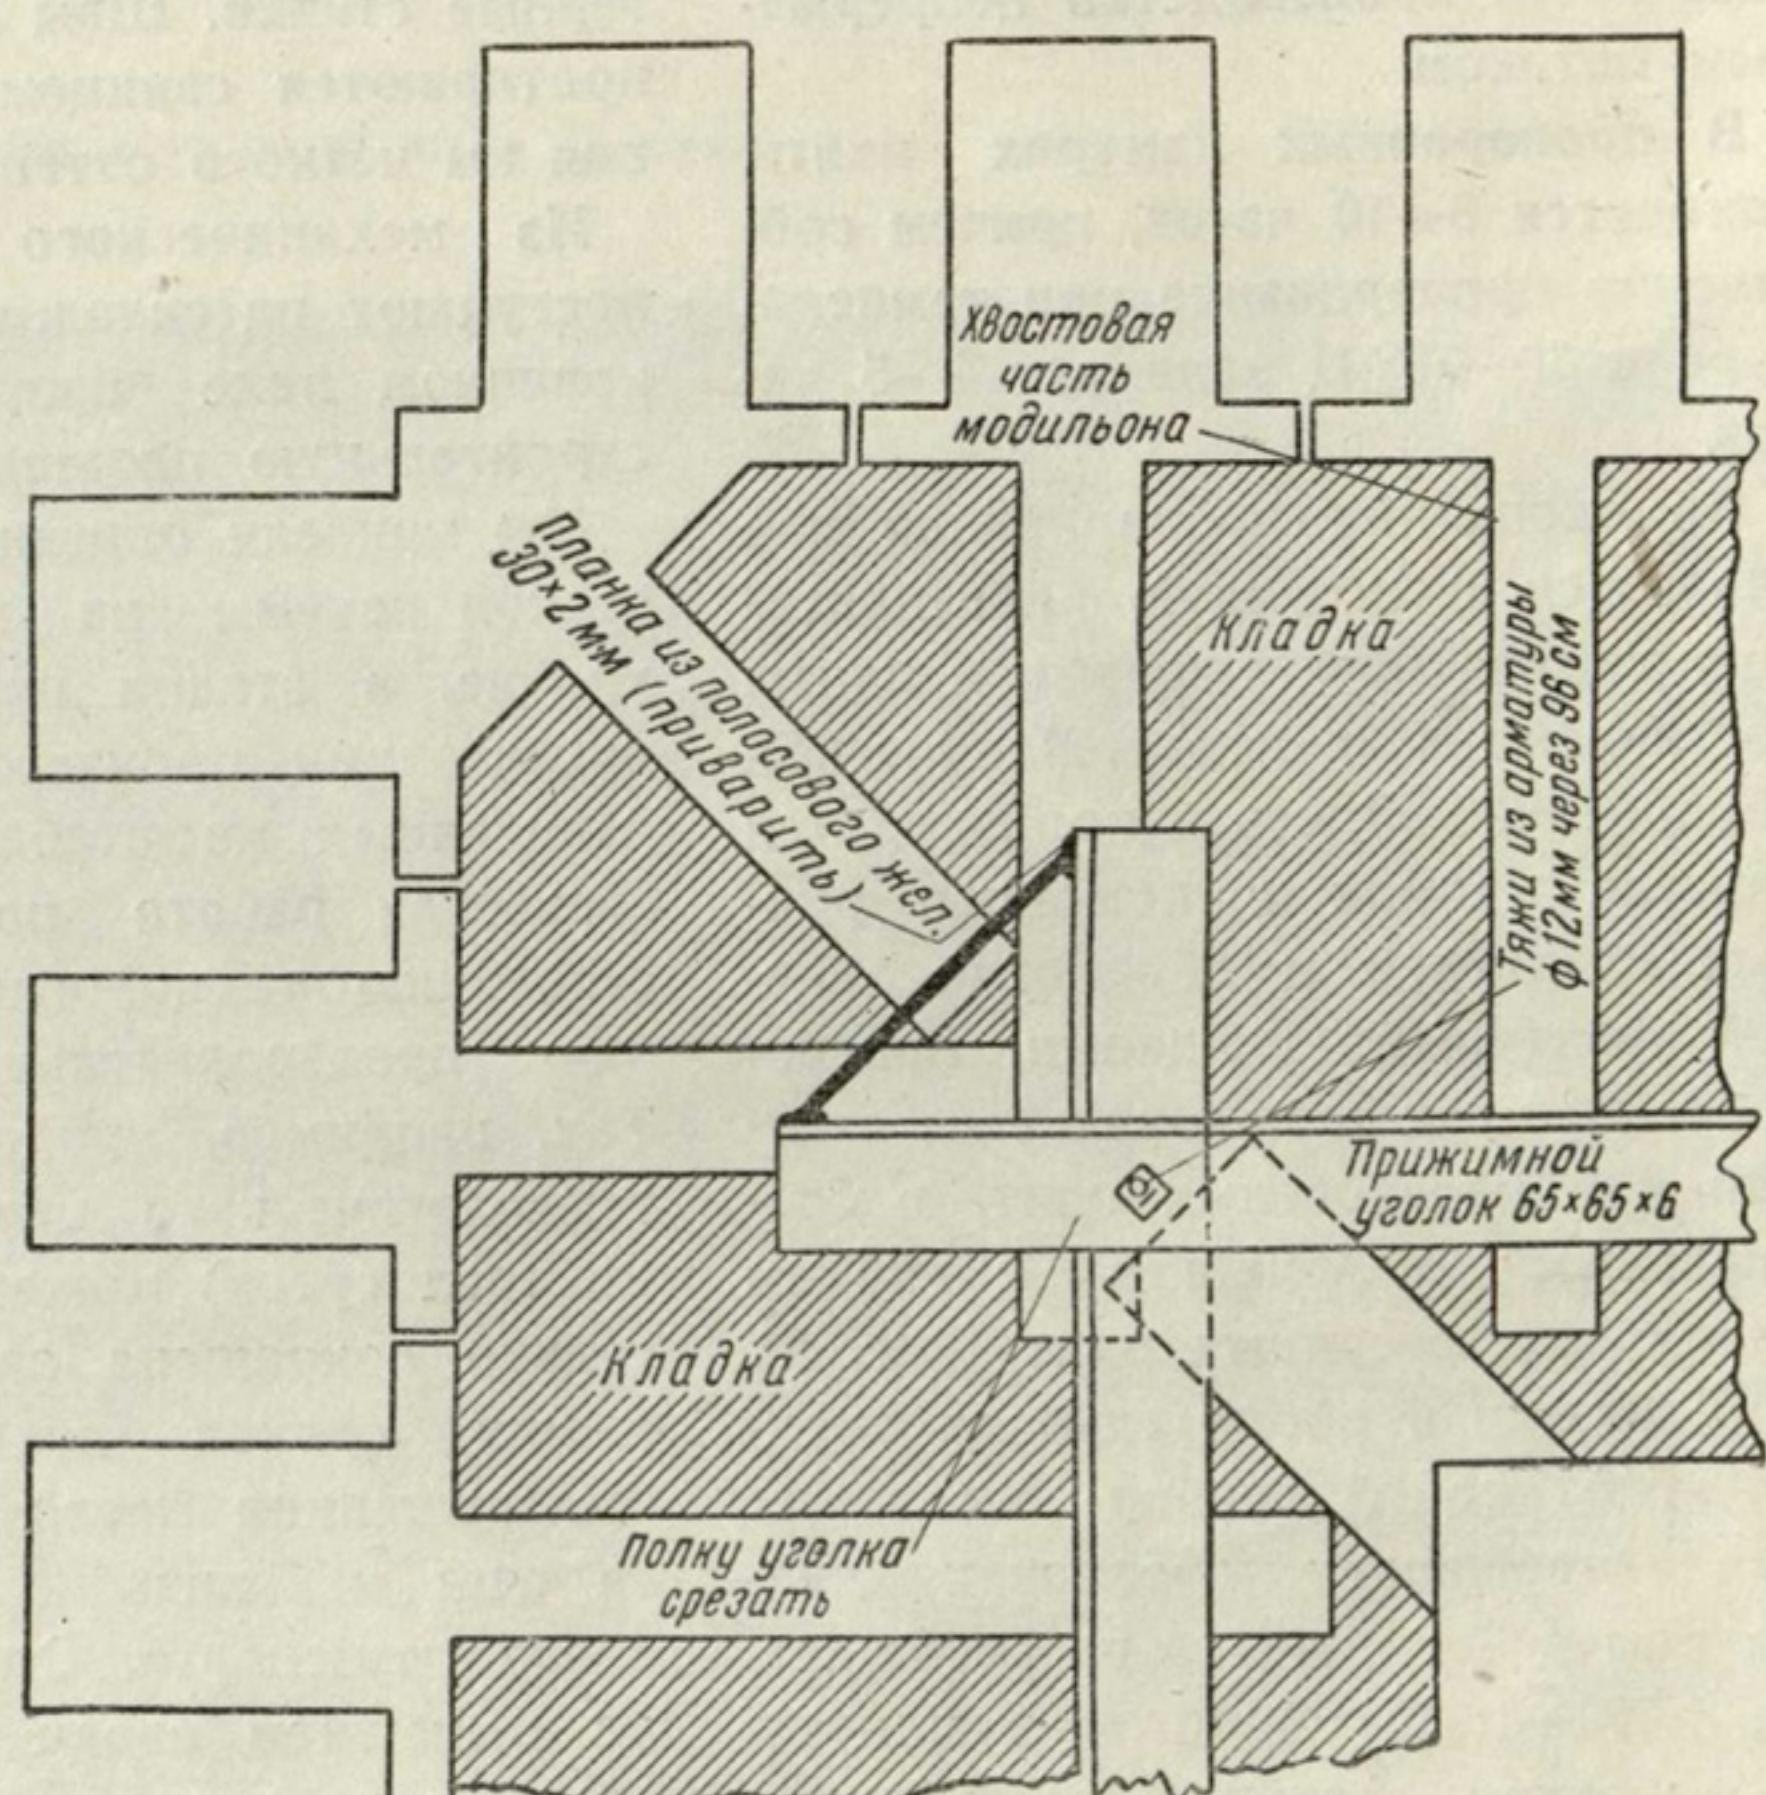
Конструкция и схема монтажа сборного венчающего карниза.
